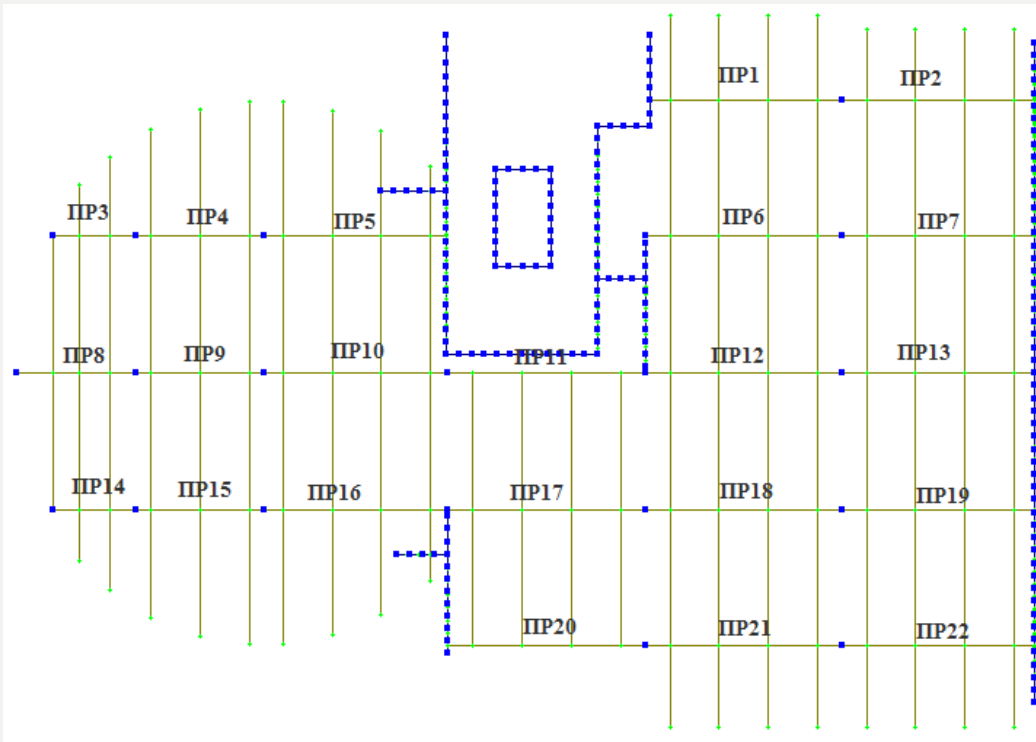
Схема розташування поздовжніх ребер перекриття (головних балок)
